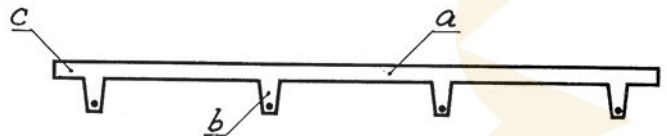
Elemento de parede de 1 m de largura por 3 m de altura sendo: «a» a capa fina de solo-cimento; «b» as nervuras de concreto; «c» a aba perimetral do elemento.
